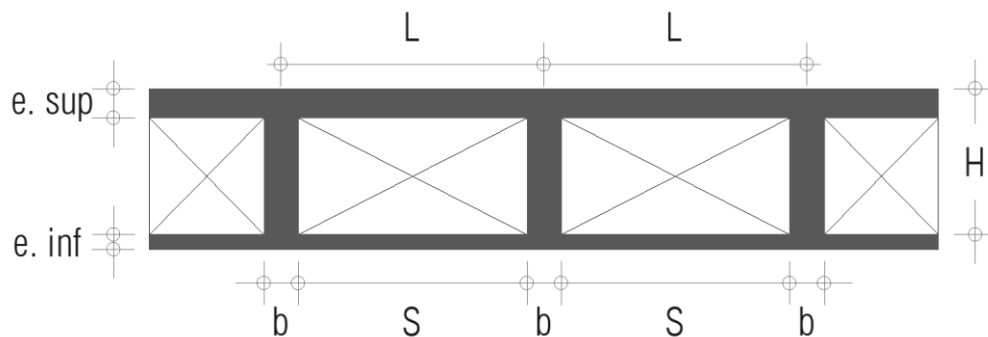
Partes de una Losa Aligerada. Fuente: Propia
